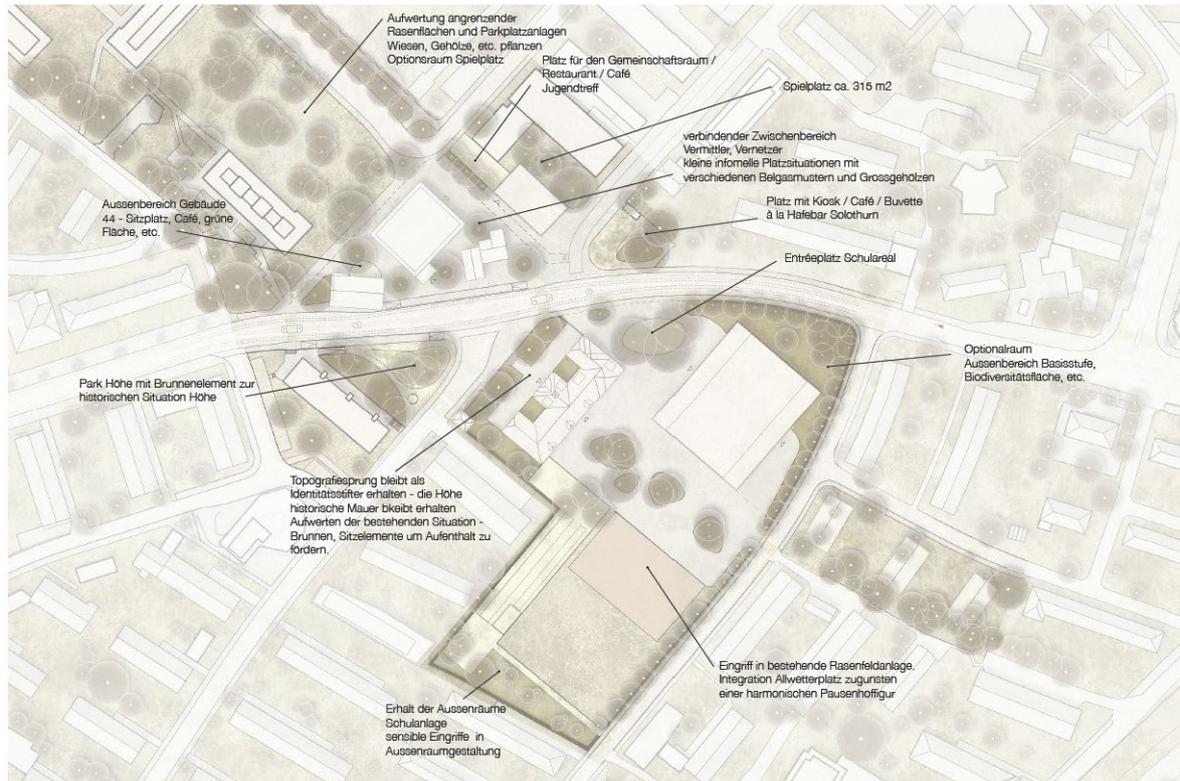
Aussenraum Szenario 2 mit Baukörper 55 M (Abschlussdokumentation, S. 18)
